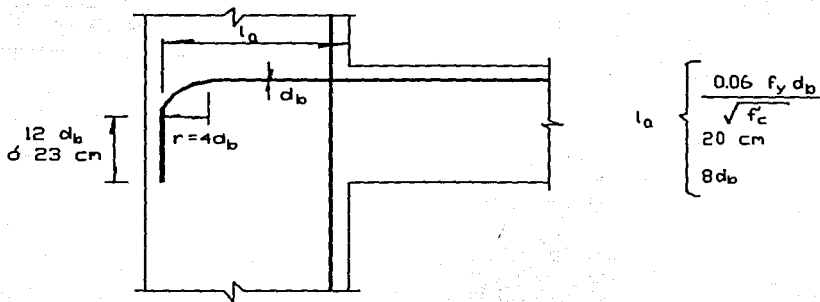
Anclaje de refuerzo longitudinal de vigas. (1.6)
